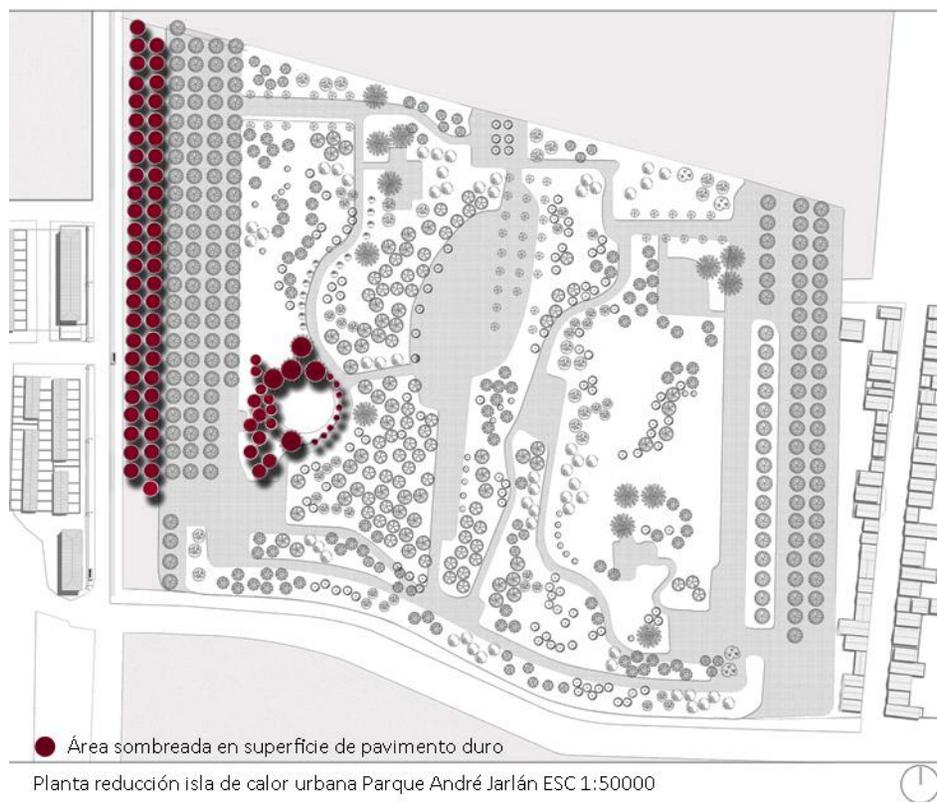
Planta reducción efecto isla de calor urbana Parque André Jarlán.
